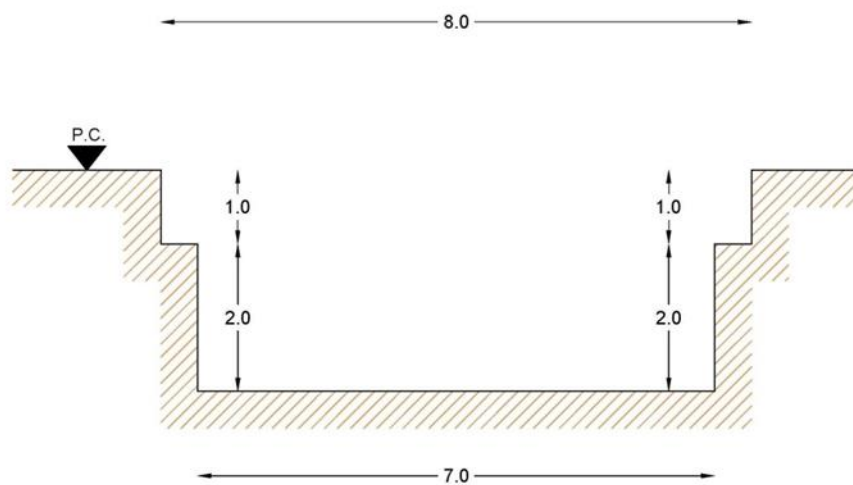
Sezione dello scavo per la realizzazione delle fondazioni
